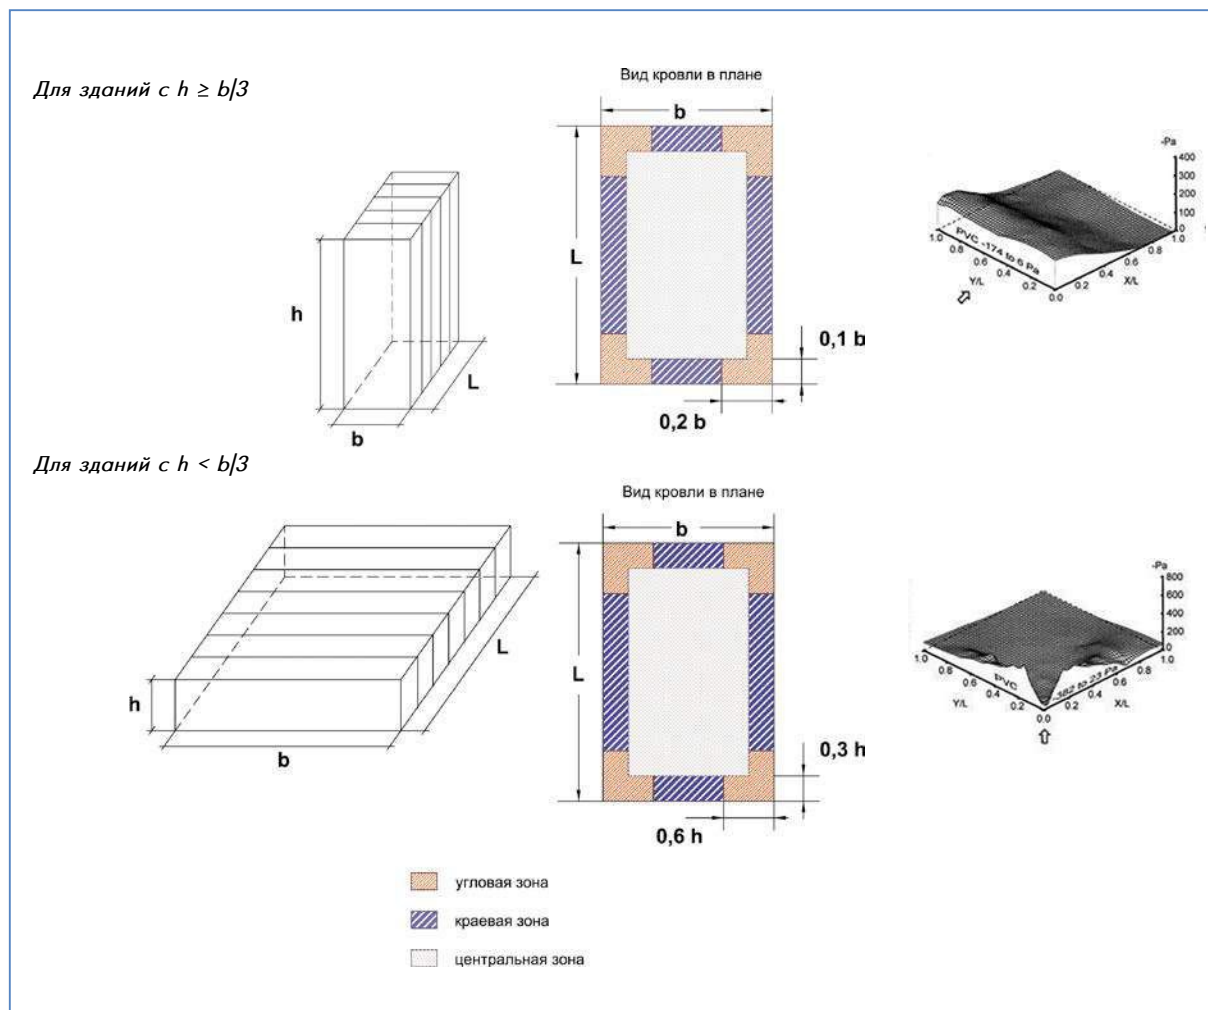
Деление кровли на зоны ветровой нагрузки.
